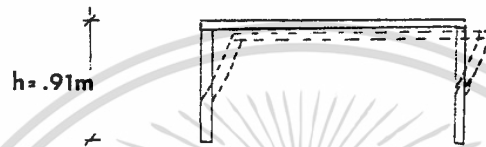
แสดงตำแหน่งของโครง trusses
